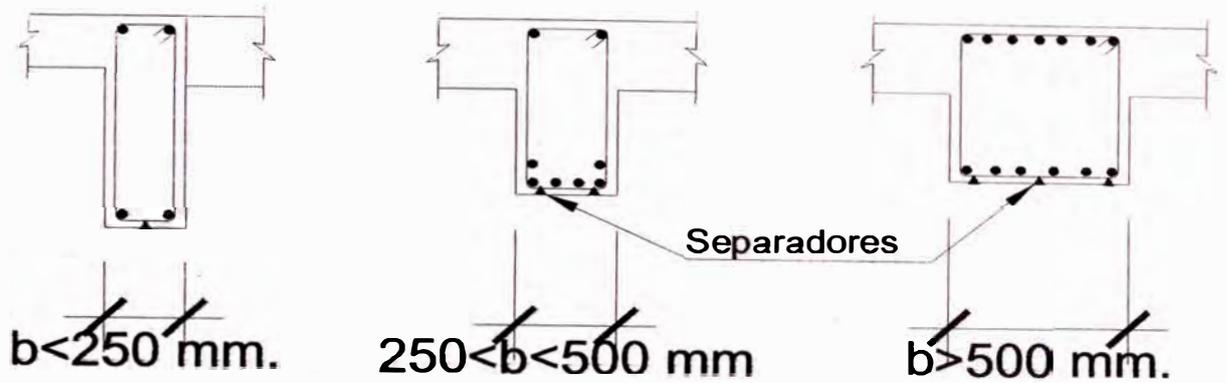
Sección de viga, se indican los separadores para cada ancho de viga. Se usan los mismos de la losa. Ver Fotografía N° 6
